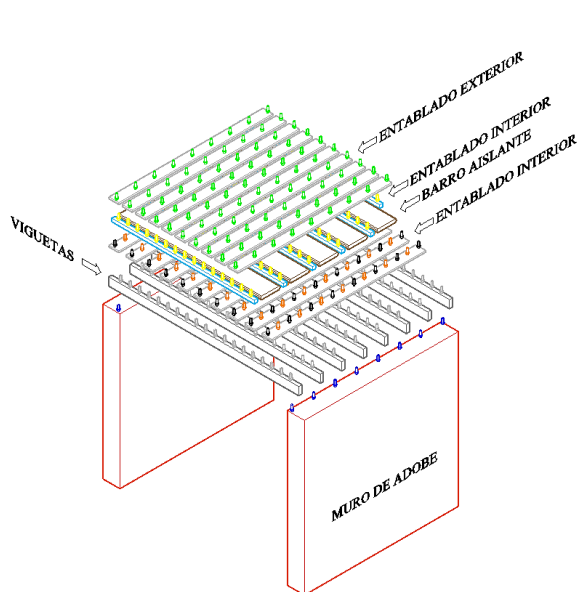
Transmisión de cargas del entrepiso al muro de adobe
